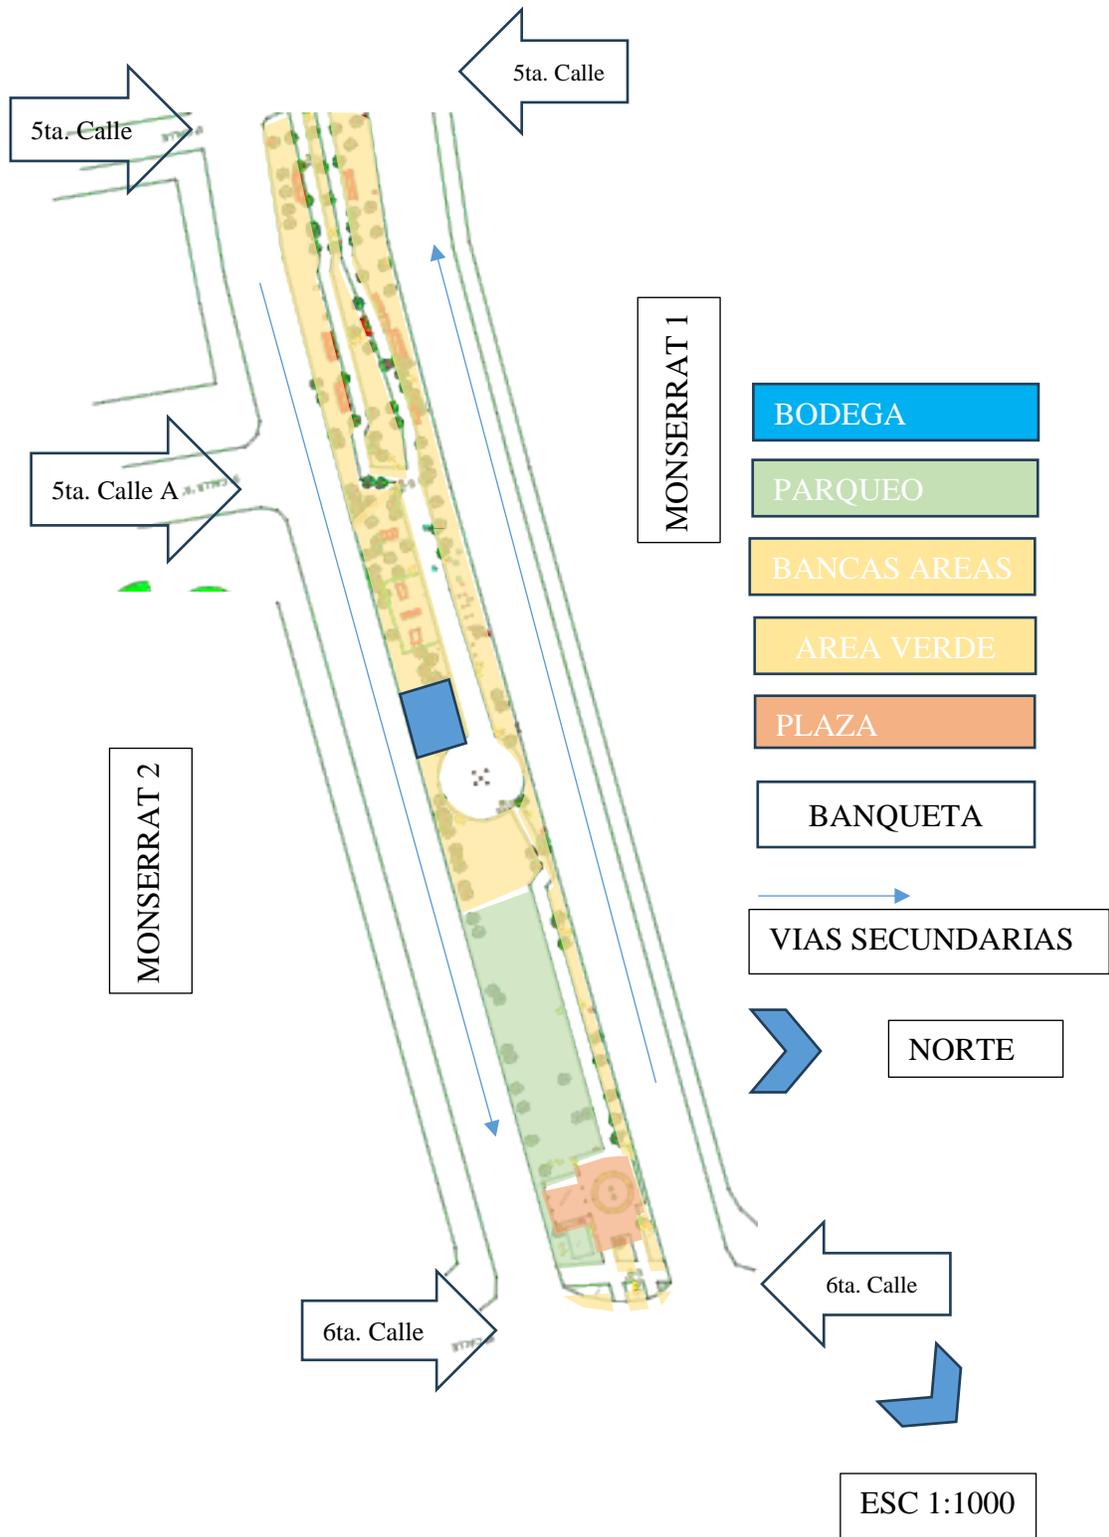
Sector 3 Existente entre 4 .ª calle A a 6 .ª calle, zona 4 de Mixco
